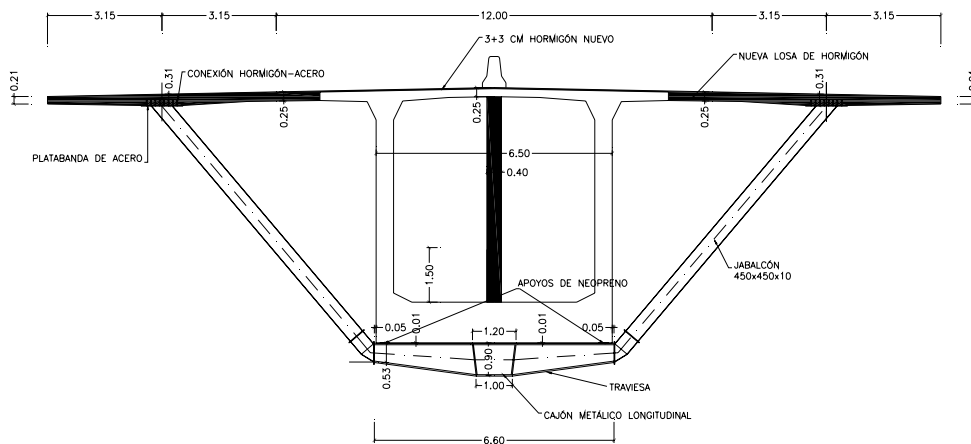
Concepción estructural de los elementos de refuerzo del tablero (sección transversal)
